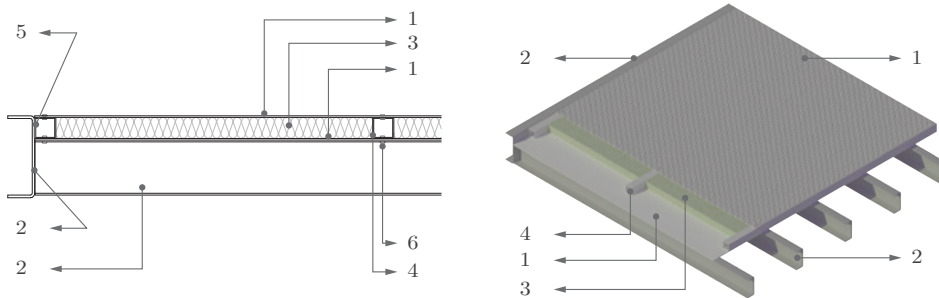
Sección constructiva 3D del habitáculo Emergency Expa Room. Fuente y elaboración: Autores.
